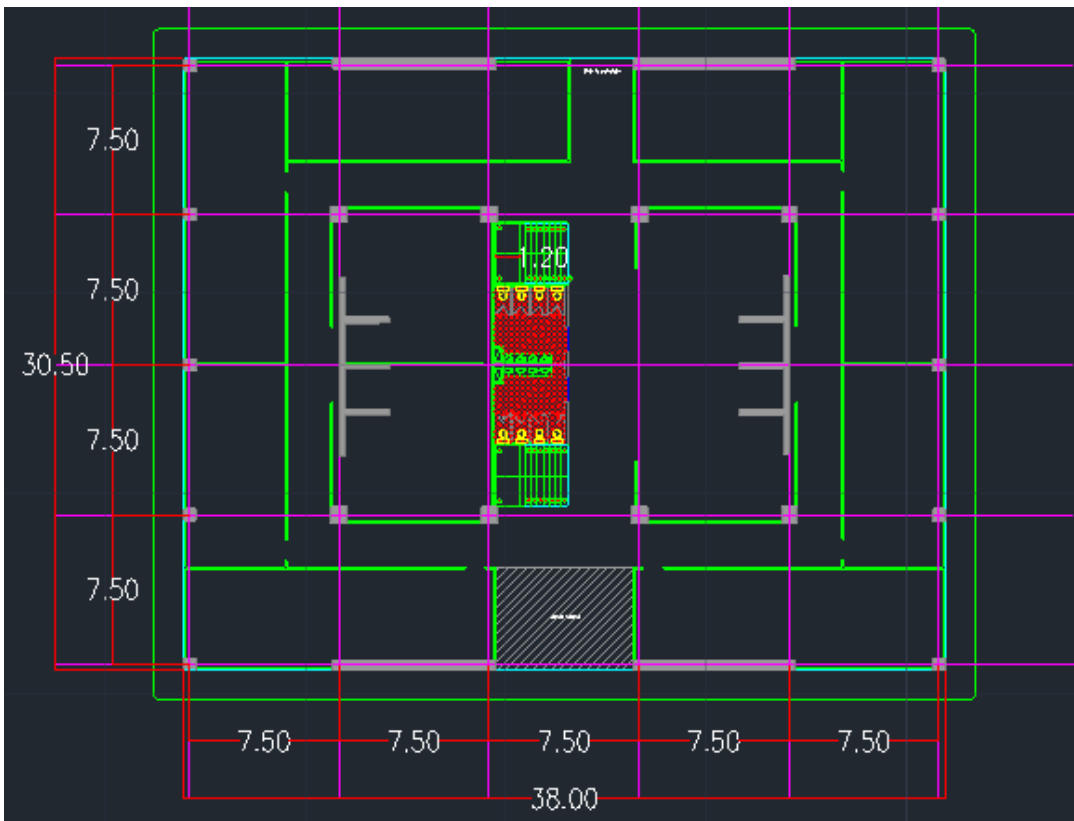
Planta Entrepiso Tipo para el Edificio de Diez Niveles.
